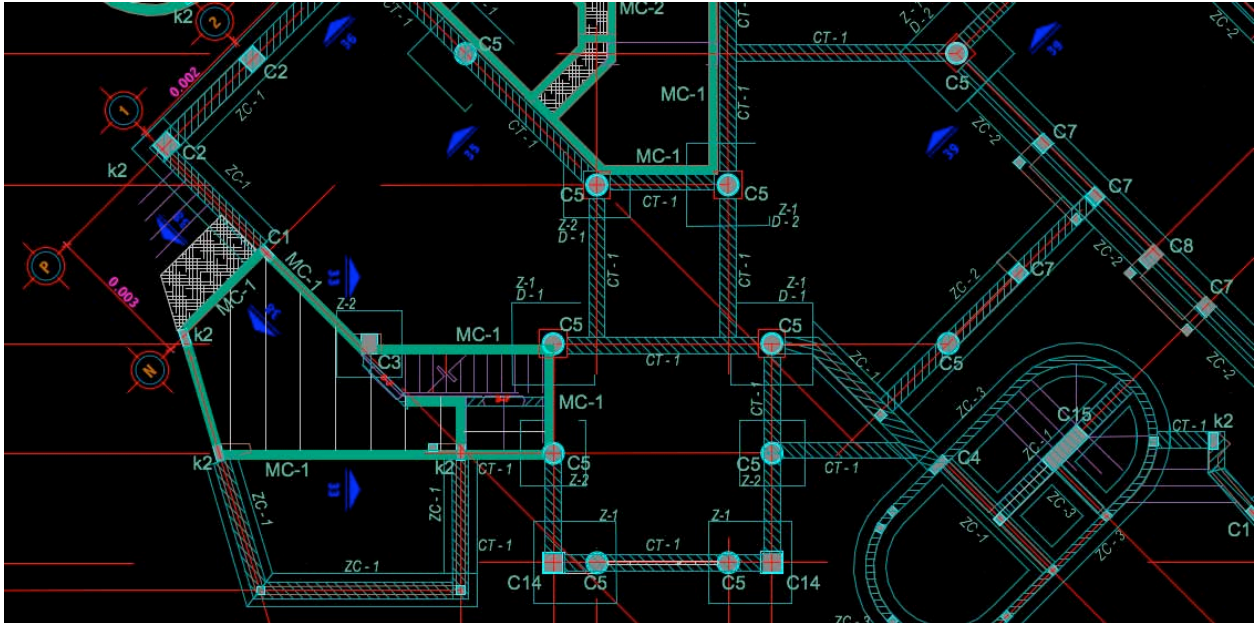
Ubicación y nomenclatura de Zapatas corridas, Zapatas Aisladas y Muros de carga de concreto
